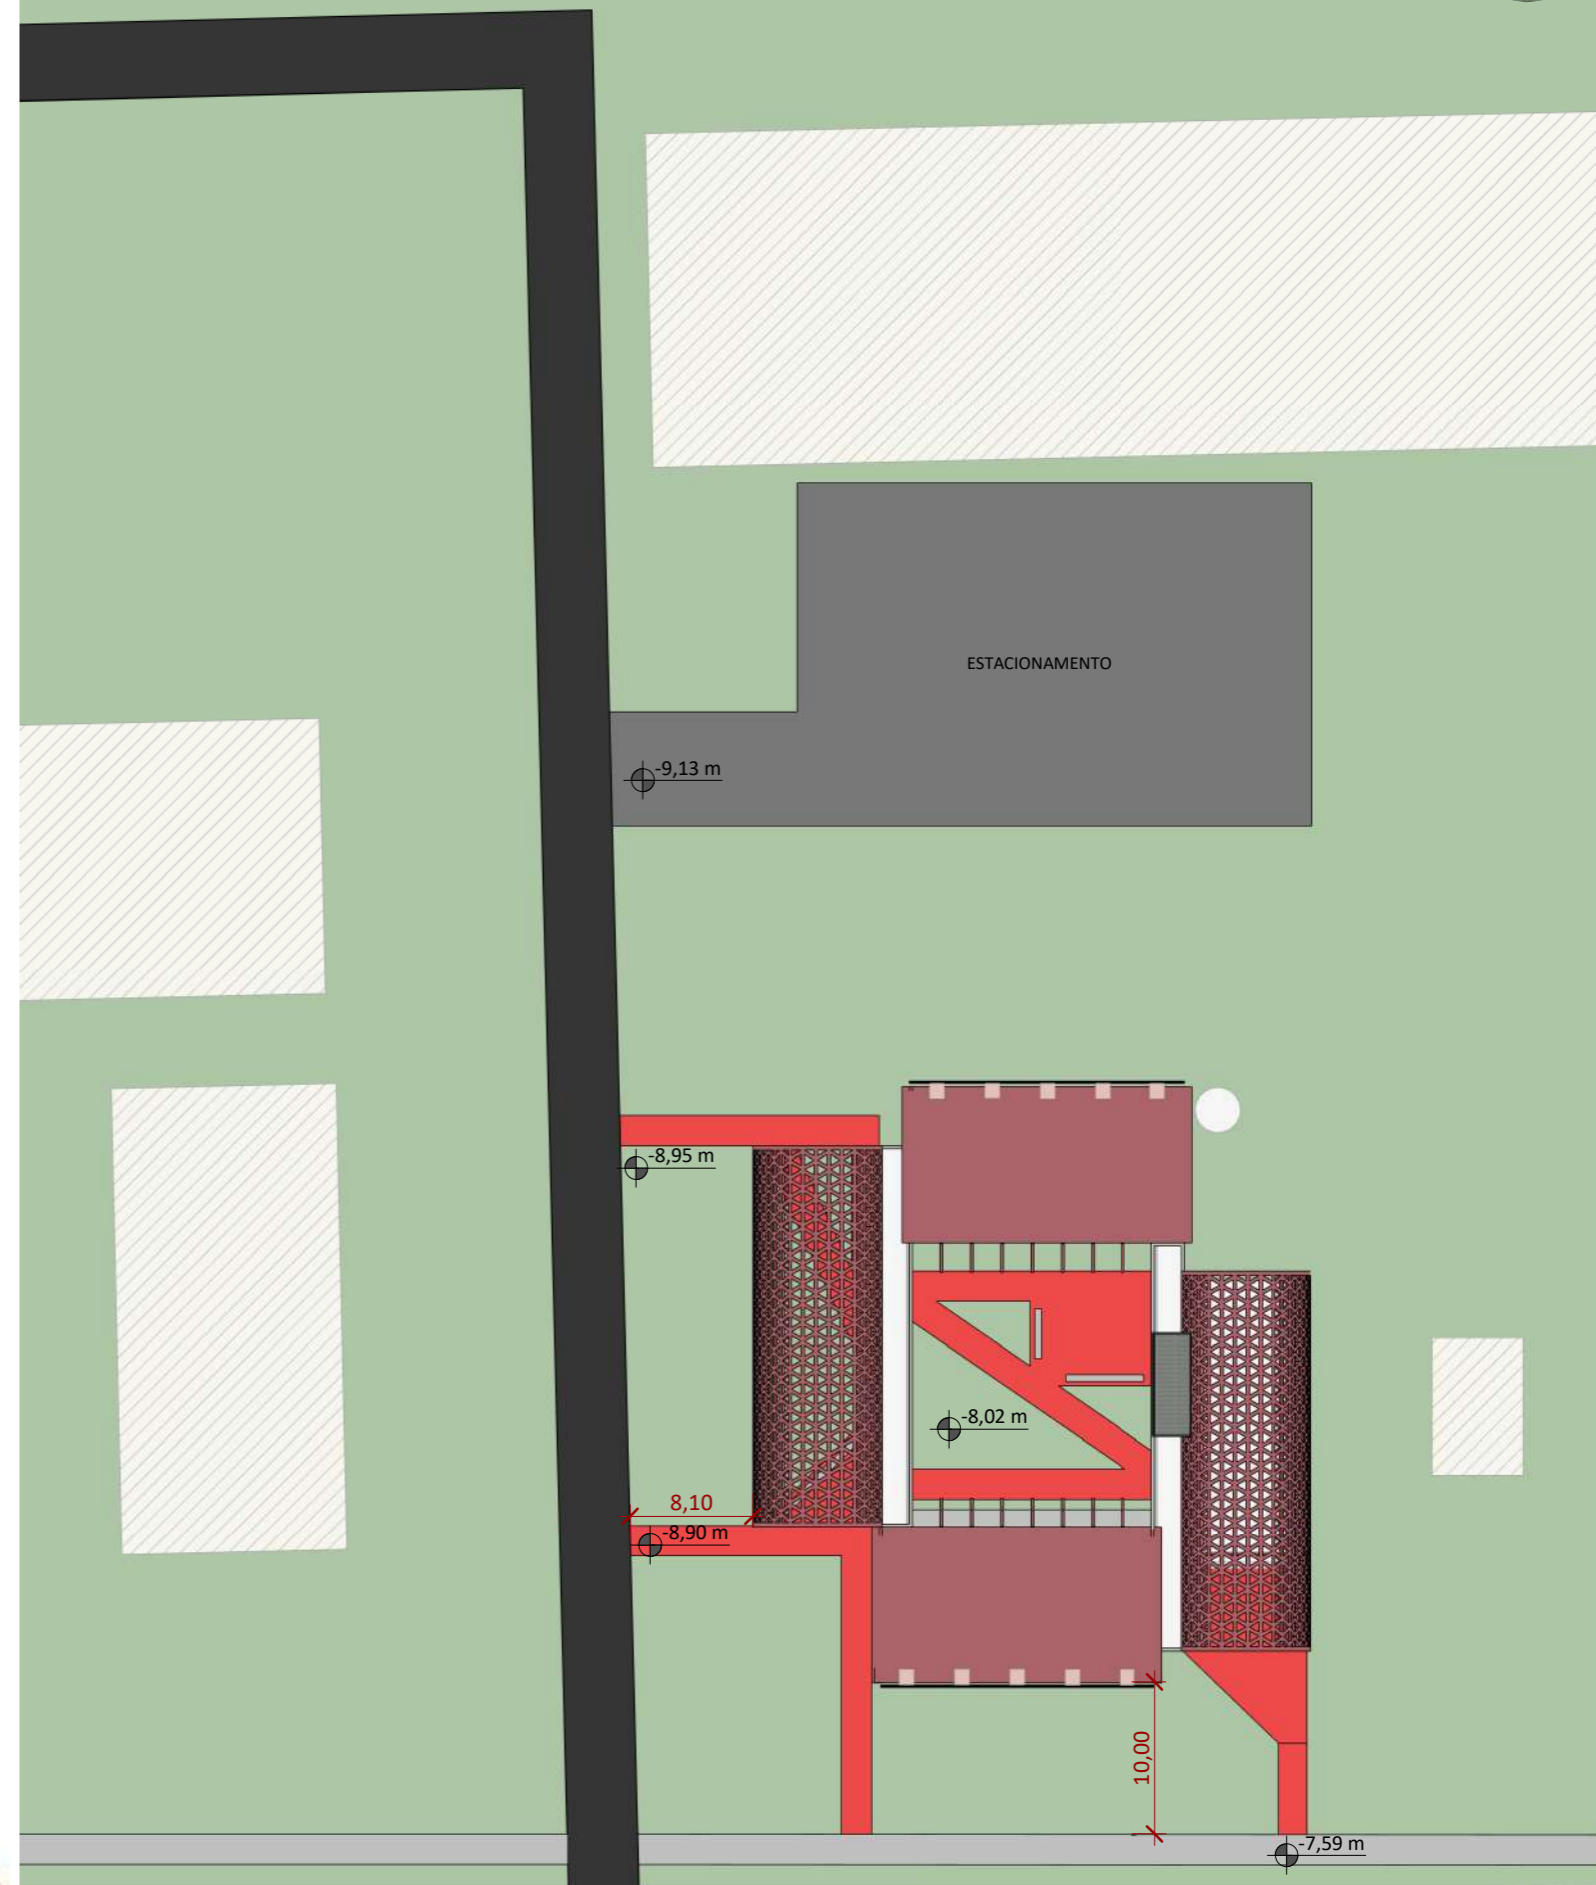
Planta de cobertura, na escala 1:500. Elaborada por Ana Coêlho.
